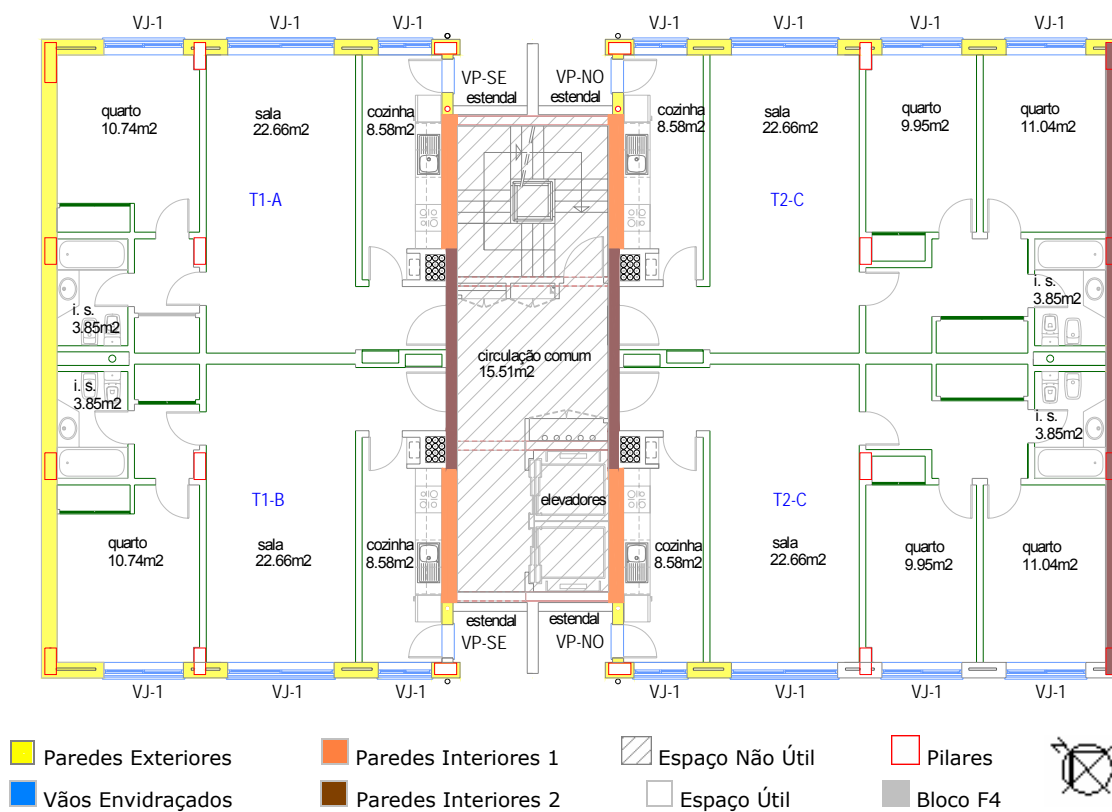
Planta Pisos 1 a 5 – Bloco F3.
